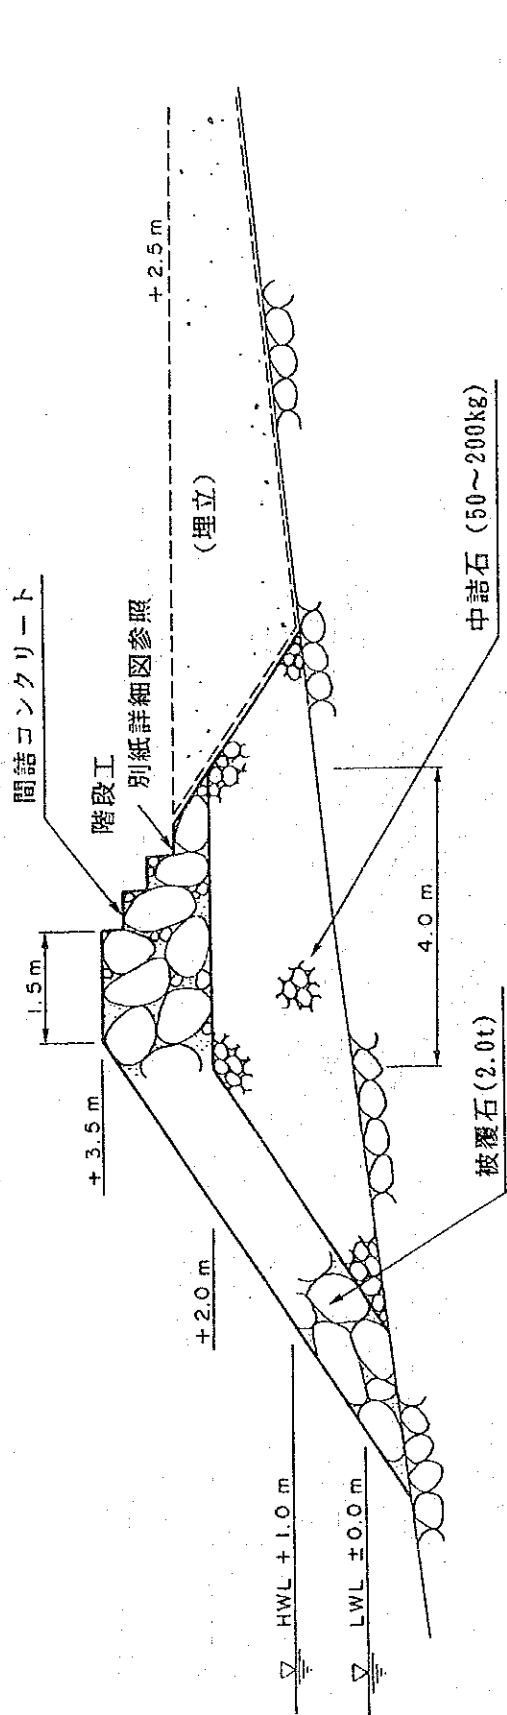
海岸保全施設、標準断面図 (C-D 区間)
